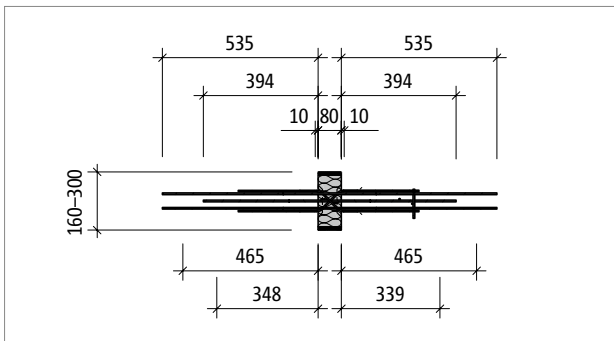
Schöck Isokorb® T Typ WL-M1: Produktgrundriss
